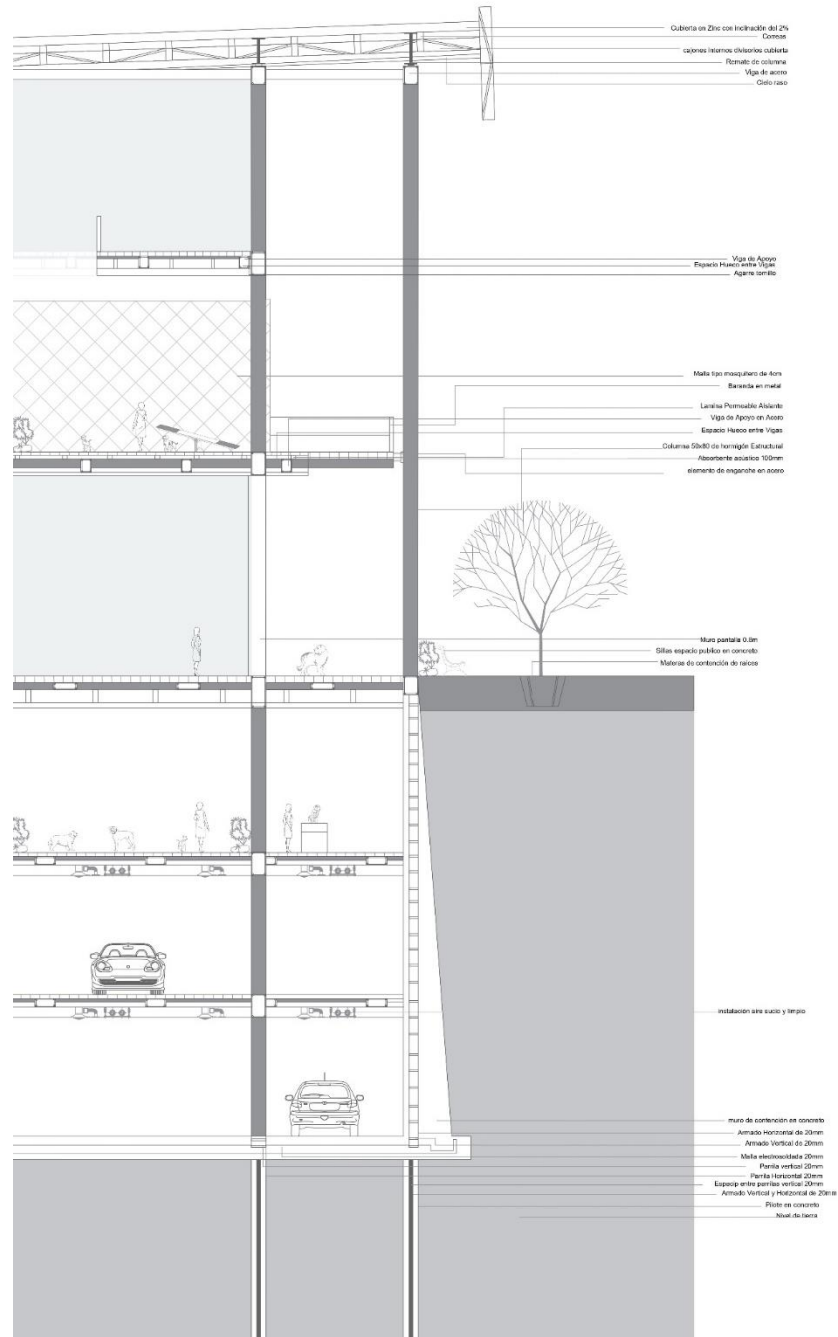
Detalle constructivo sistema estructural – Elaboración propia
